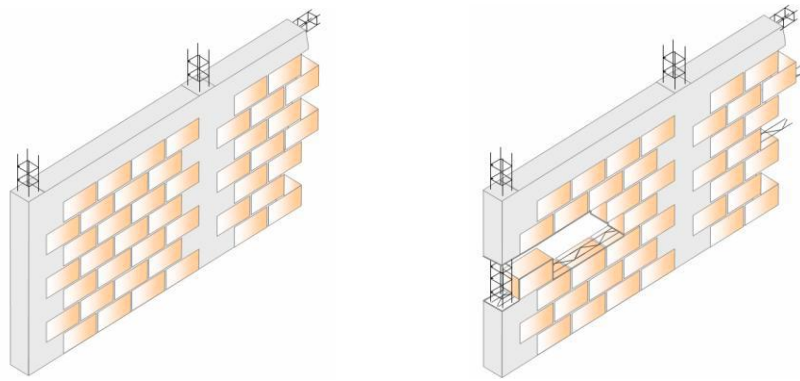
Alvenaria confinada com elementos de betão armado de face à vista e alvenaria confinada com armadura de junta horizontal (Gouveia et al., 2007).
